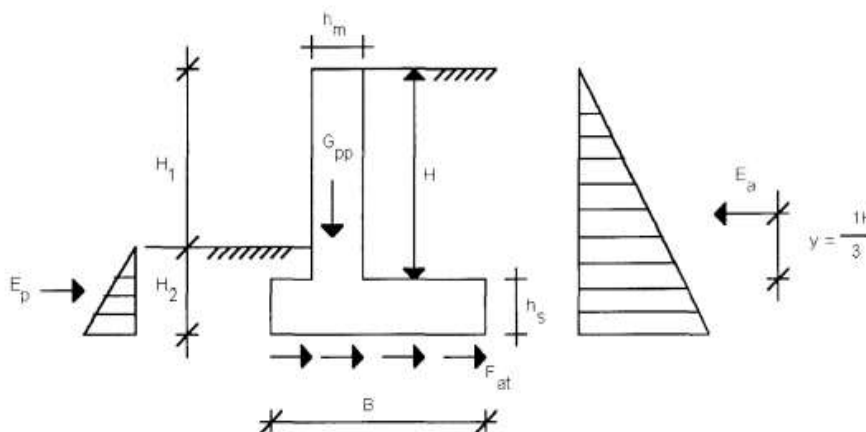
Muro de concreto armado por flexão, perfil clássico.
